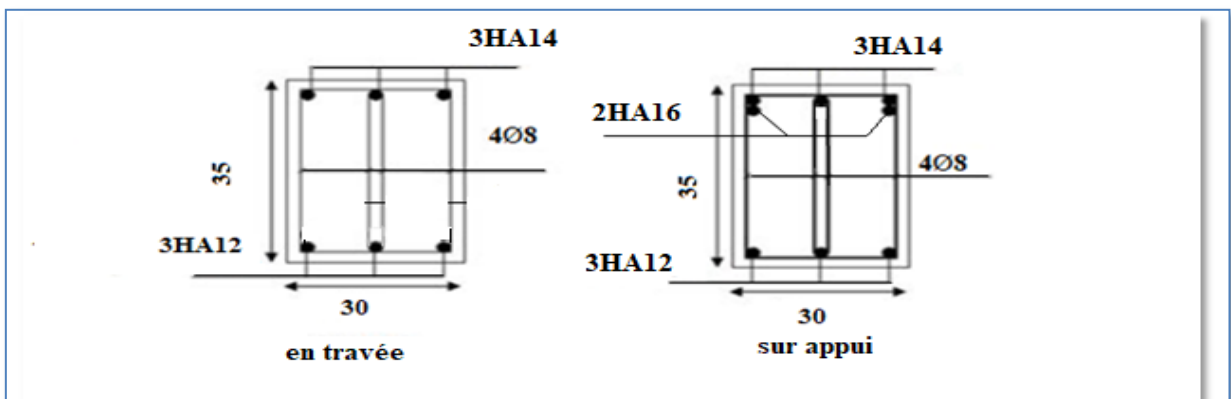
Ferraillage de la Poutre secondaire (30x35)
